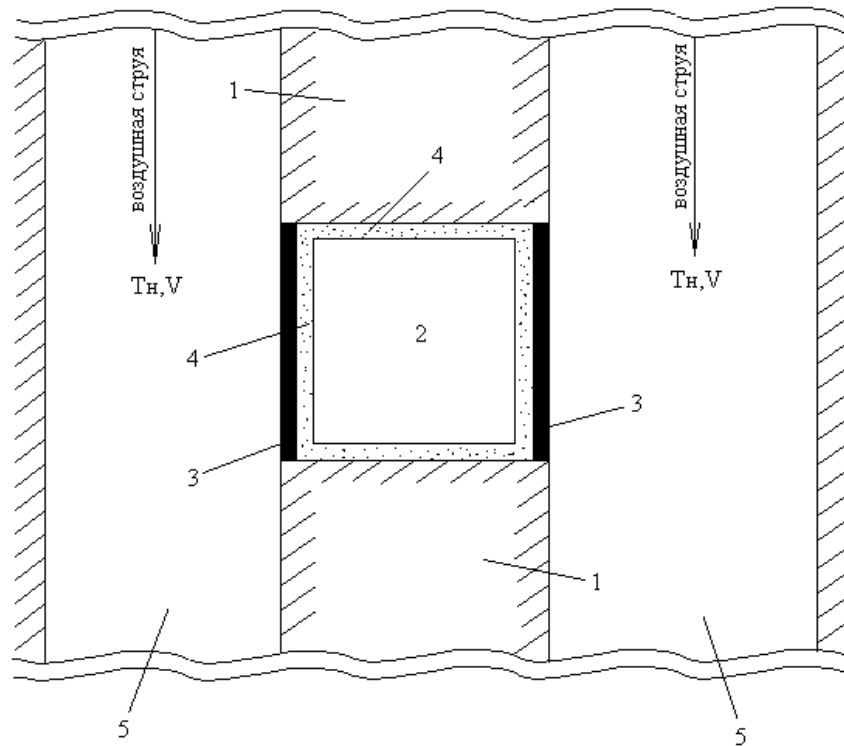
Схема расположения камеры ожидания в руднике (план): 1 — целик; 2 — камера ожидания; 3 — бетонные перегородки; 4 — теплозащитное покрытие; 5 — подходы выработки
